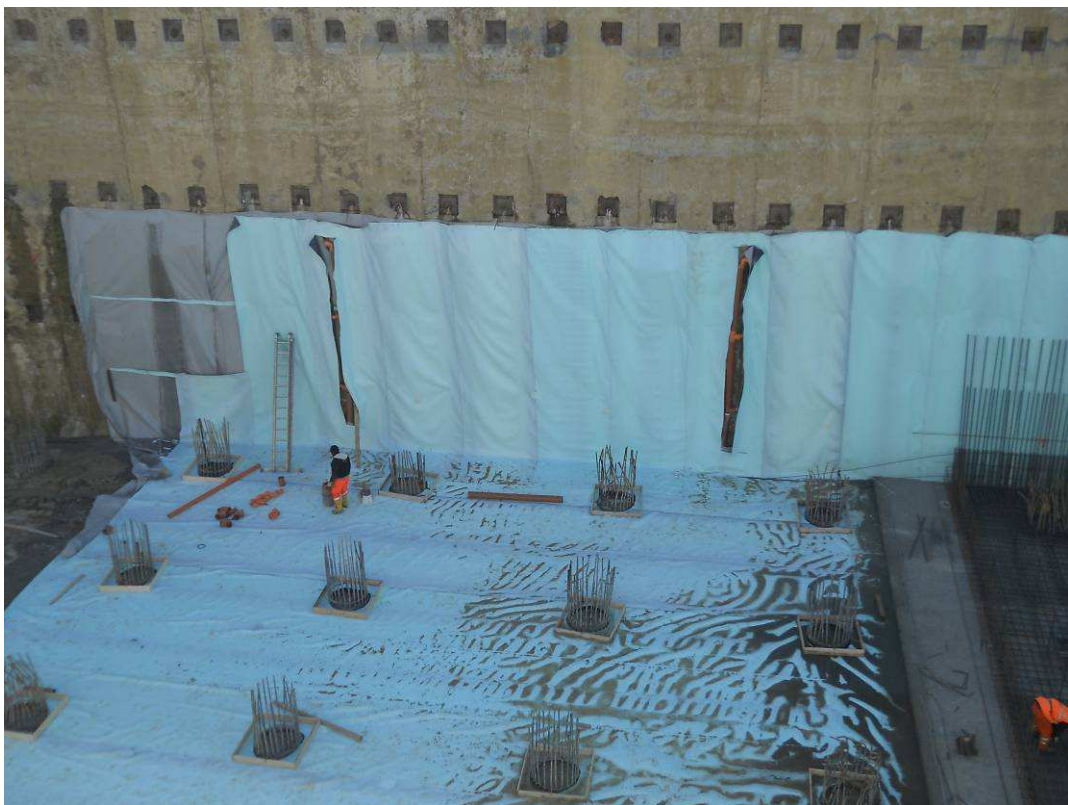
Pozzo Lancio Frese – impermeabilizzazione struttura interna
